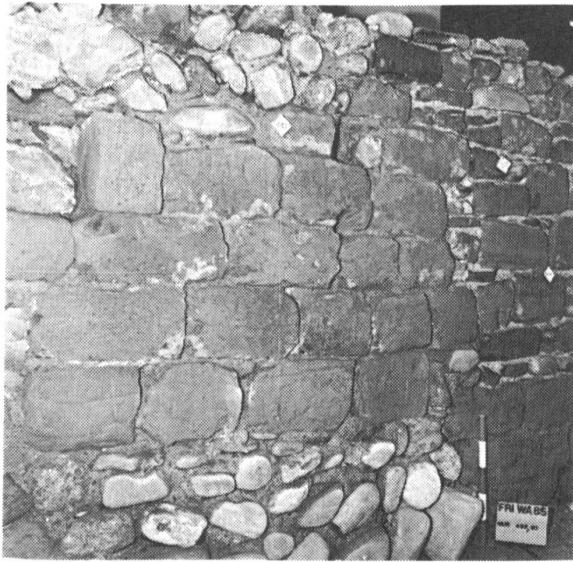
Rue du Pont-Suspendu 74–75. Segment du mur oriental de la maison n° 234 avec, en bas, la fondation de cailloux d'une première cave.
